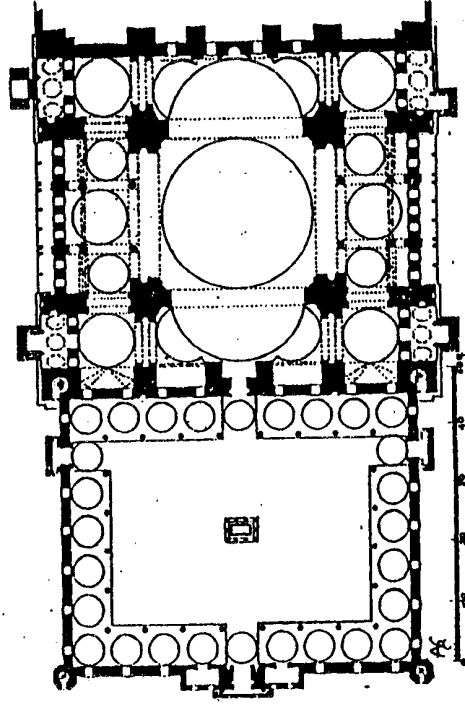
مسقط أفقي لجامع السليمية بقونية
